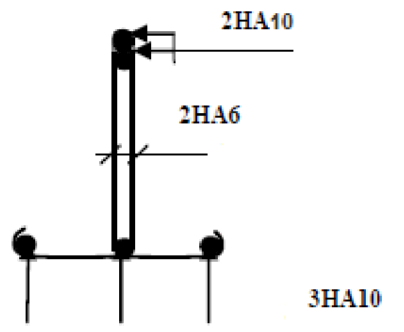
plan de ferrailage de la poutrelle.
